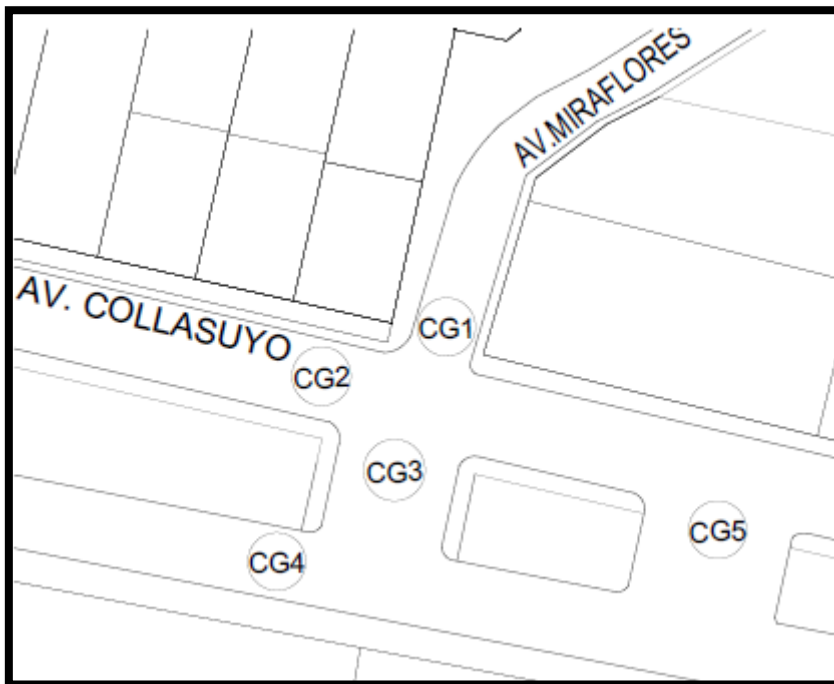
Codificación de calzada en la intersección Av. Collasuyo – Av. Miraflores
